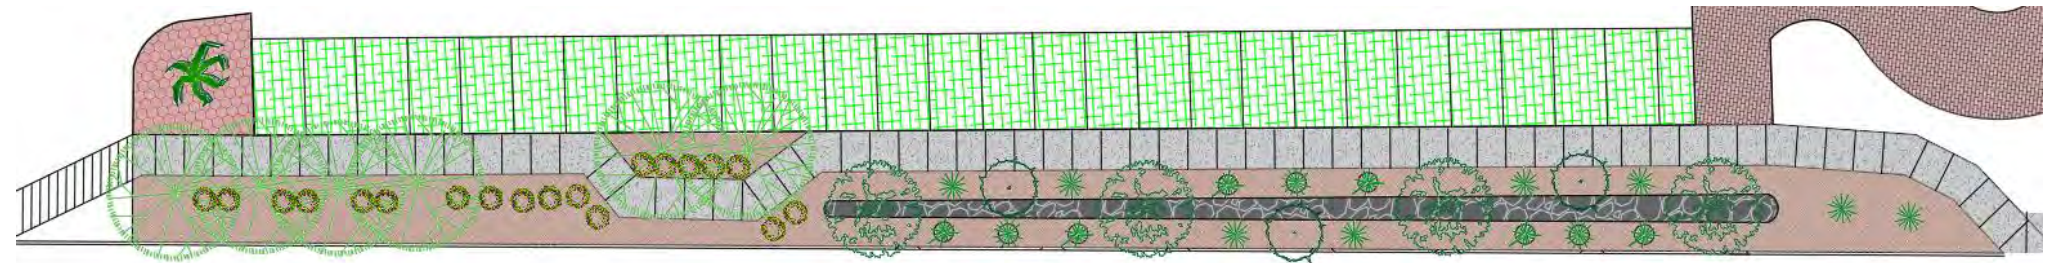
Jardín de lluvia tipo 1 planta. Elaboración propia
